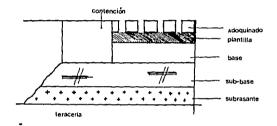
SECCION TRANSVERSAL TIPICA DE UN PAVIMENTO DE ADOQUINES
